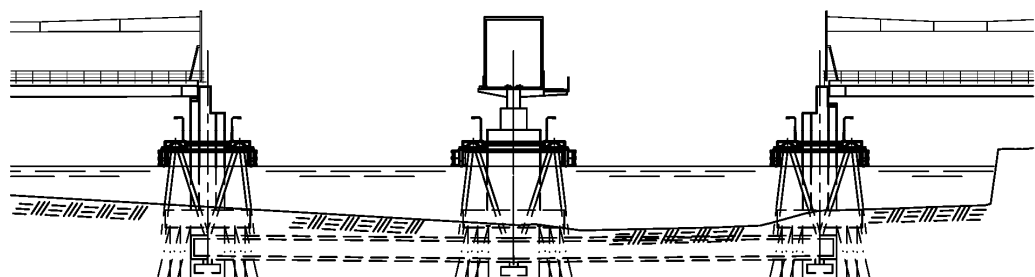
utdrag från ritning 531500-2001, tillhörande Systemhandlingen. Elevation Bro i öppet läge.
